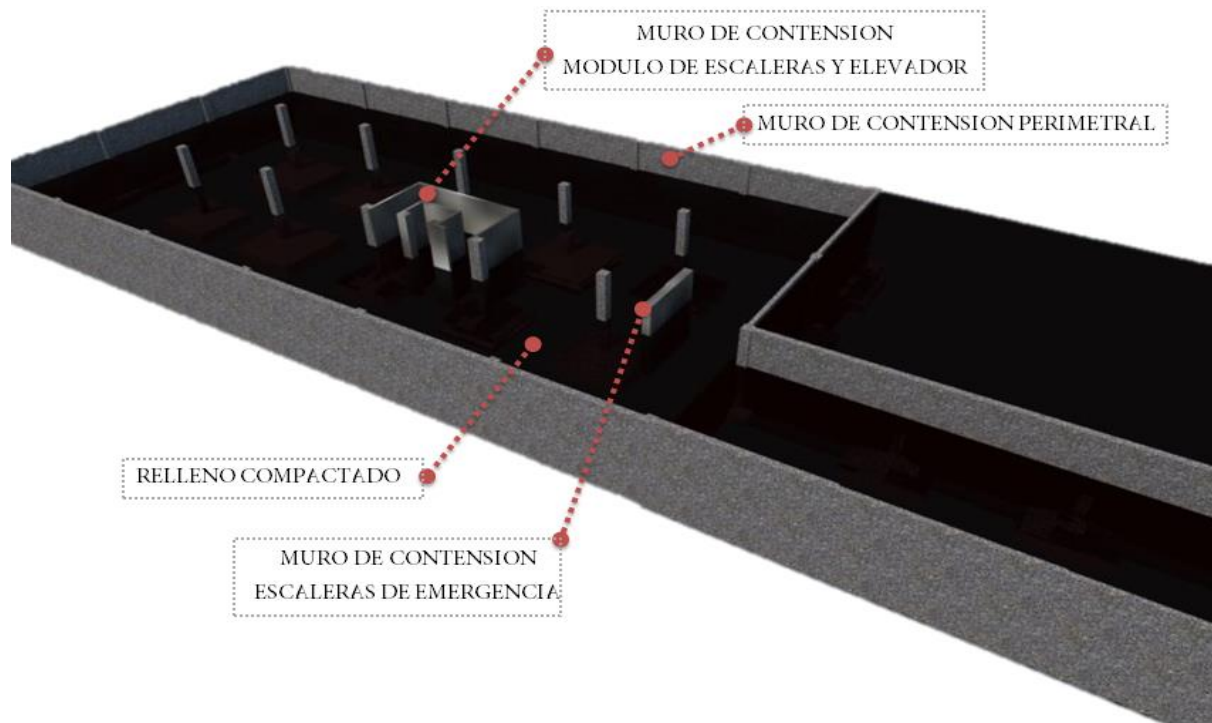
Modelo 3D muros de Contención. Autor: Carmen López.
